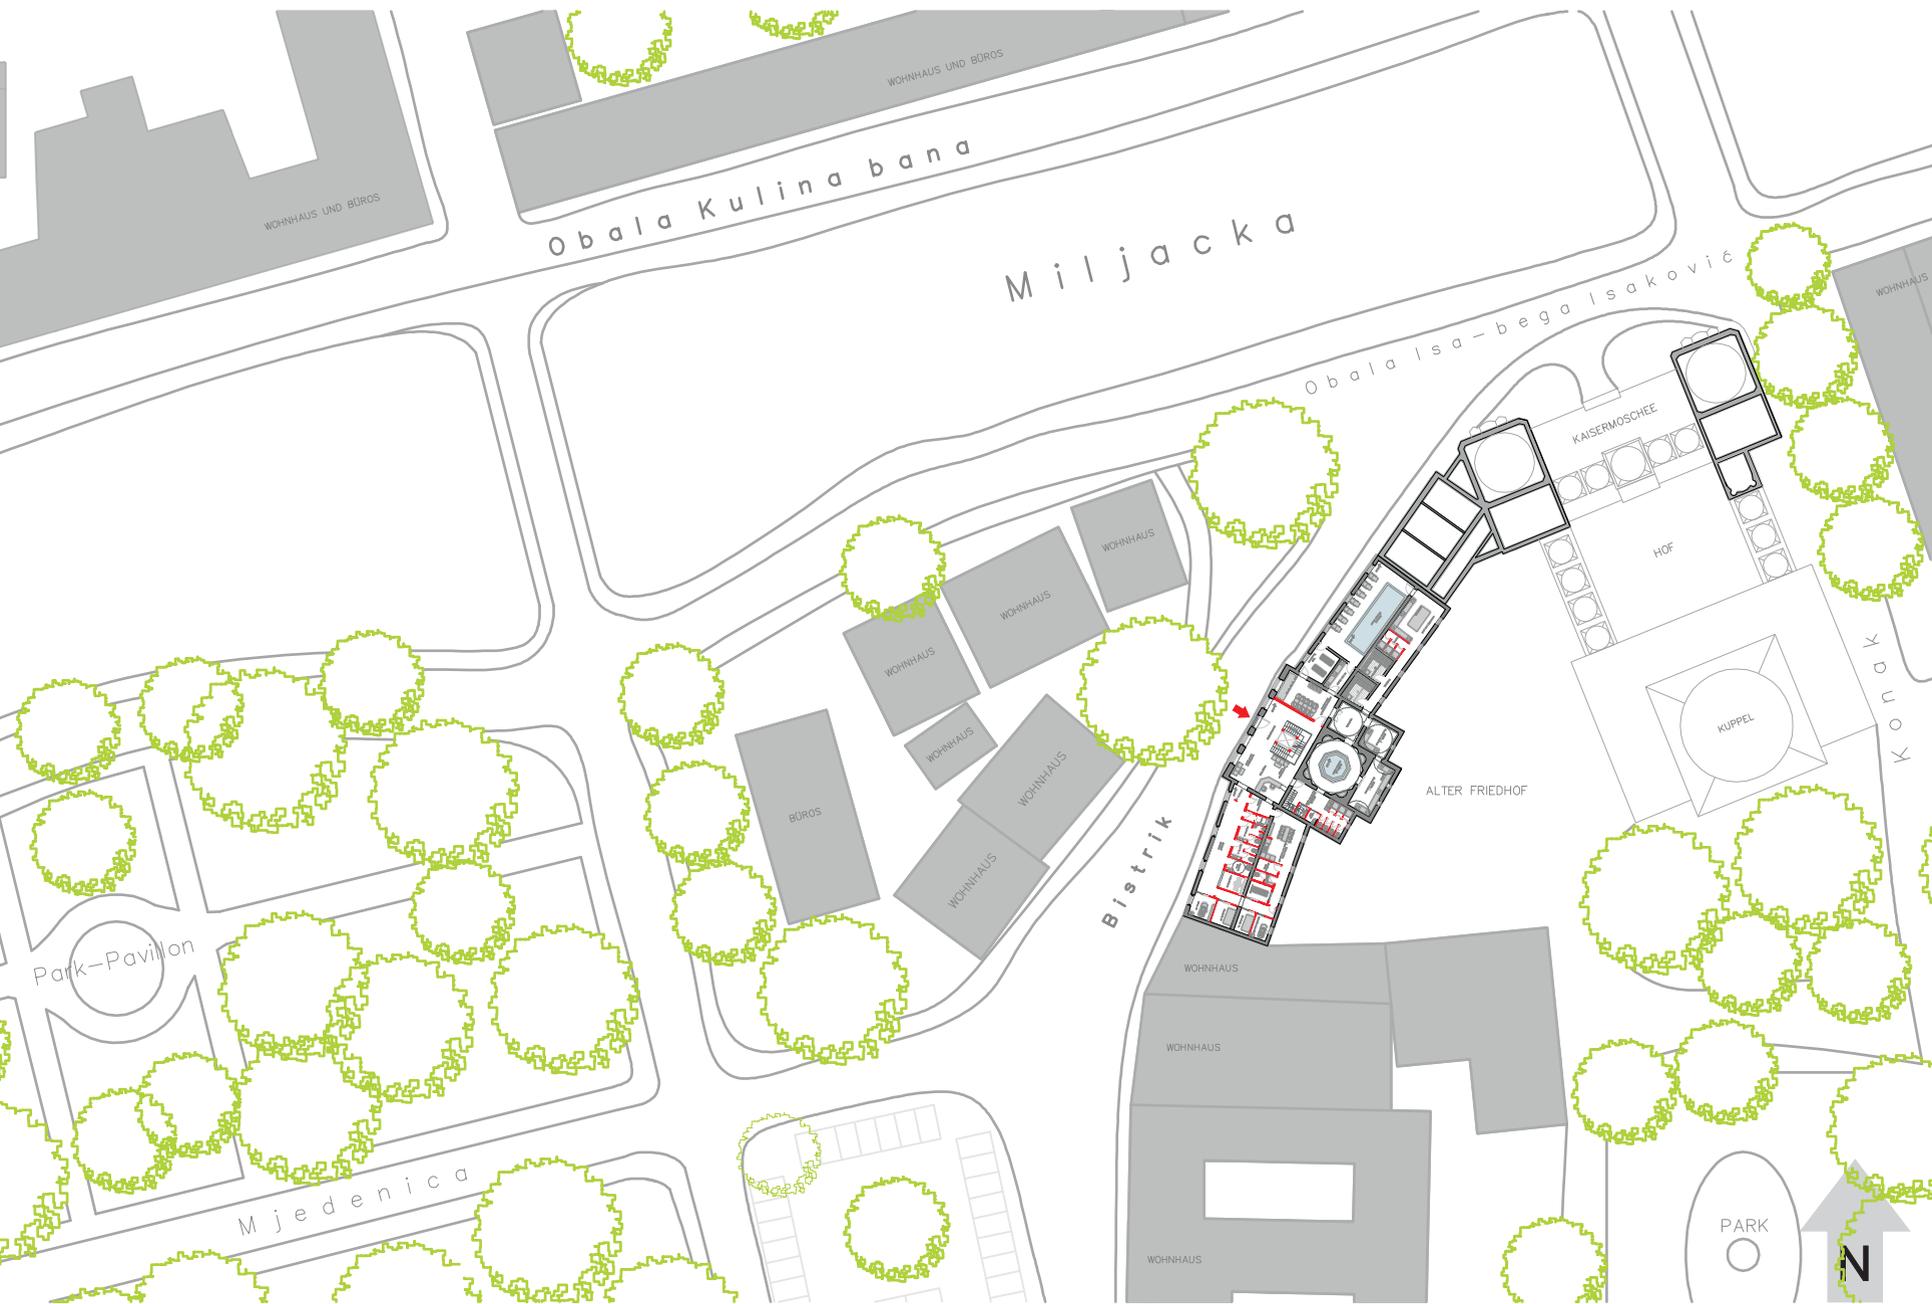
Lageplan mit dem Hammam und der Kaisermoschee
